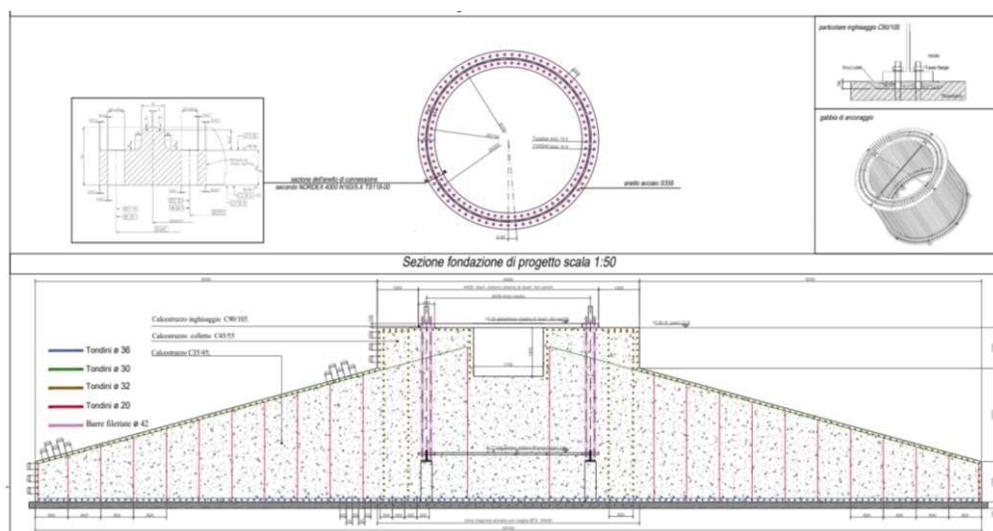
Schema grafico Fondazione tipo (sezione e armatura inferiore)
